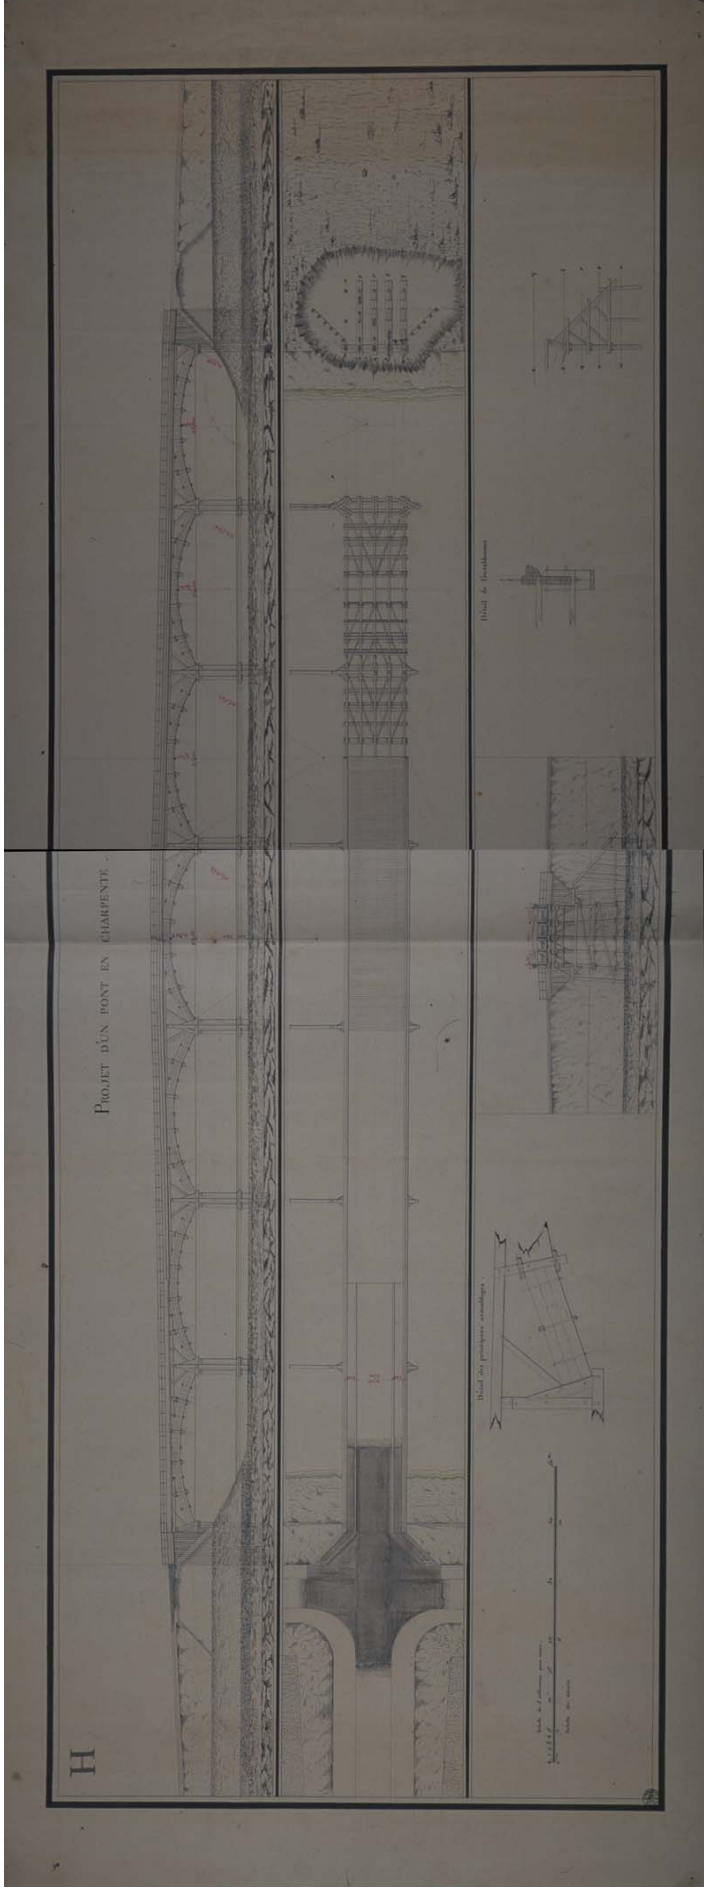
DG 473 – Louis Duval. Projet de pont en charpente. Elevation, plan coupe et details. Concours architecture. 1798-1799
